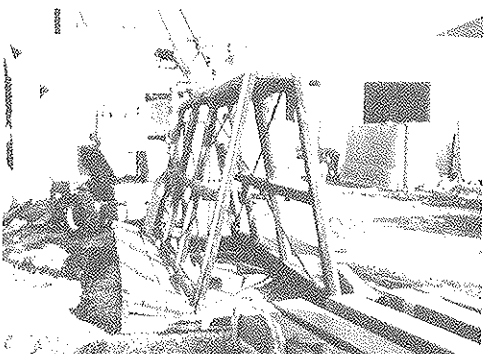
Uppställning av väggelement i fackställ (Strängbetong)
